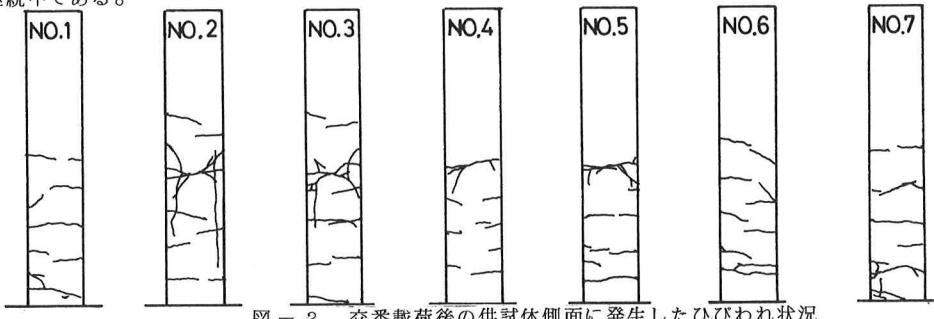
交番載荷後の供試体側面に発生したひびわれ状況
